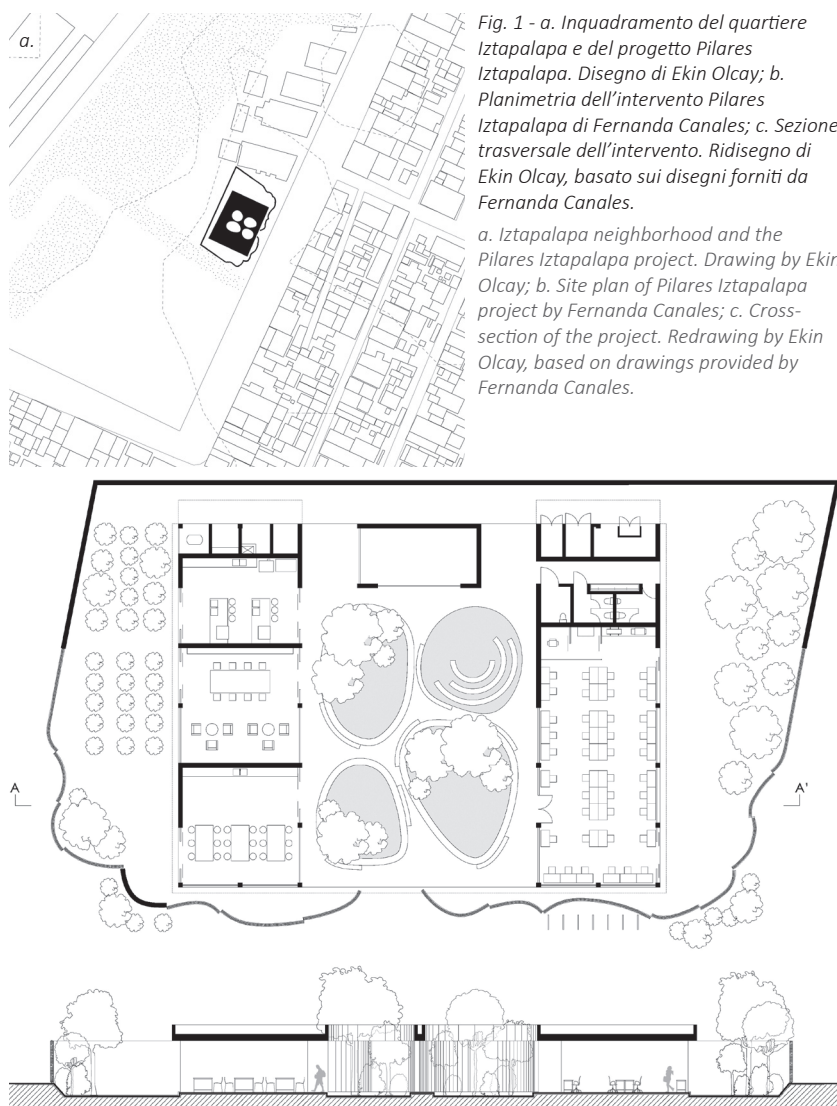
a. Inquadramento del quartiere Iztapalapa e del progetto Pilares Iztapalapa. Disegno di Ekin Olcay; b. Planimetria dell'intervento Pilares Iztapalapa di Fernanda Canales; c. Sezione trasversale dell'intervento. Ridisegno di Ekin Olcay, basato sui disegni forniti da Fernanda Canales.
